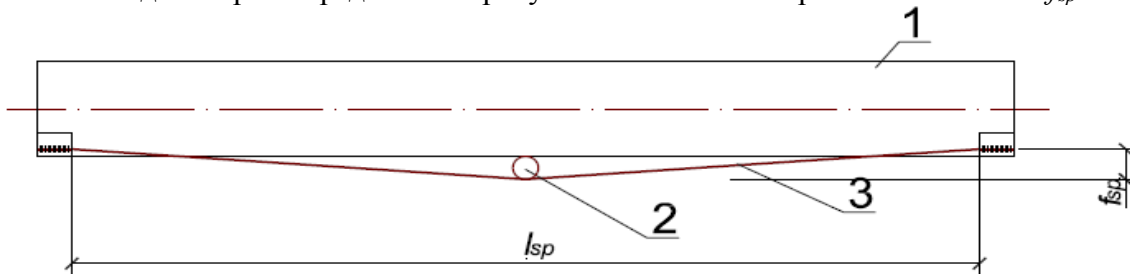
Локально предварительно напряженная железобетонная балка:
